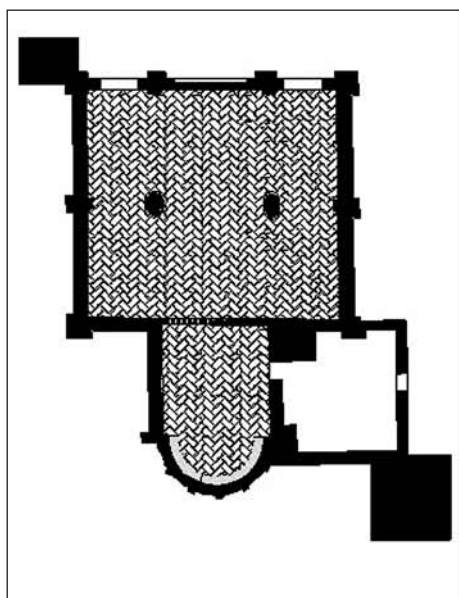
Planimetria della chiesa con rappresentazione della pavimentazione interna in cotto (di recente fattura).
